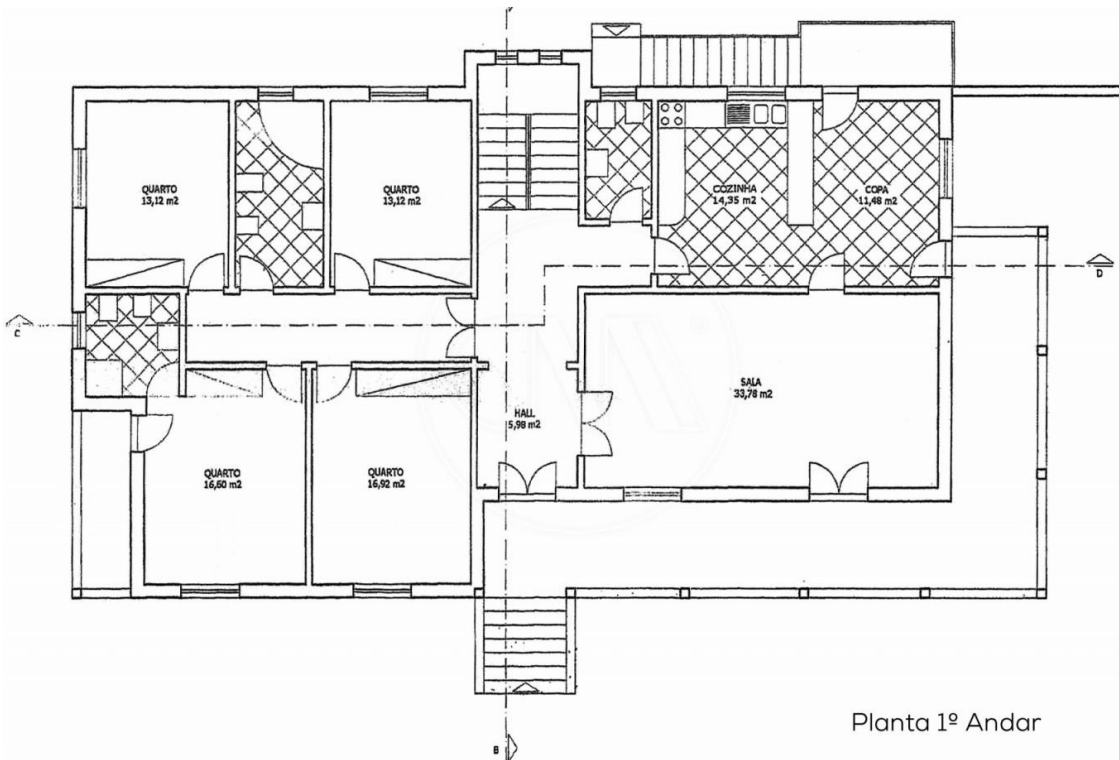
Planta do Piso Superior. Fonte: Cliente.
